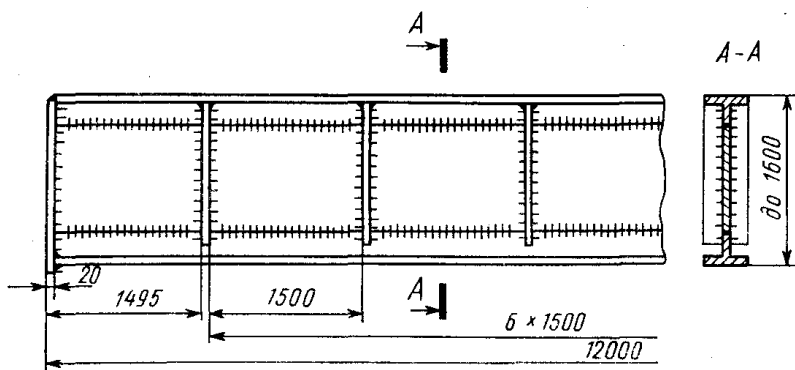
Подкрановая балка с поясами из широкополочных тавров
